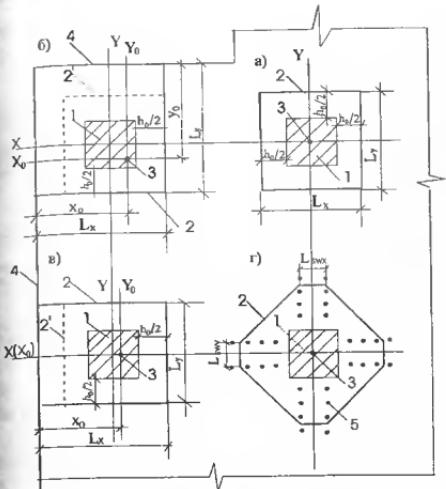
Схема расчетных контуров поперечного сечения при продавливании
